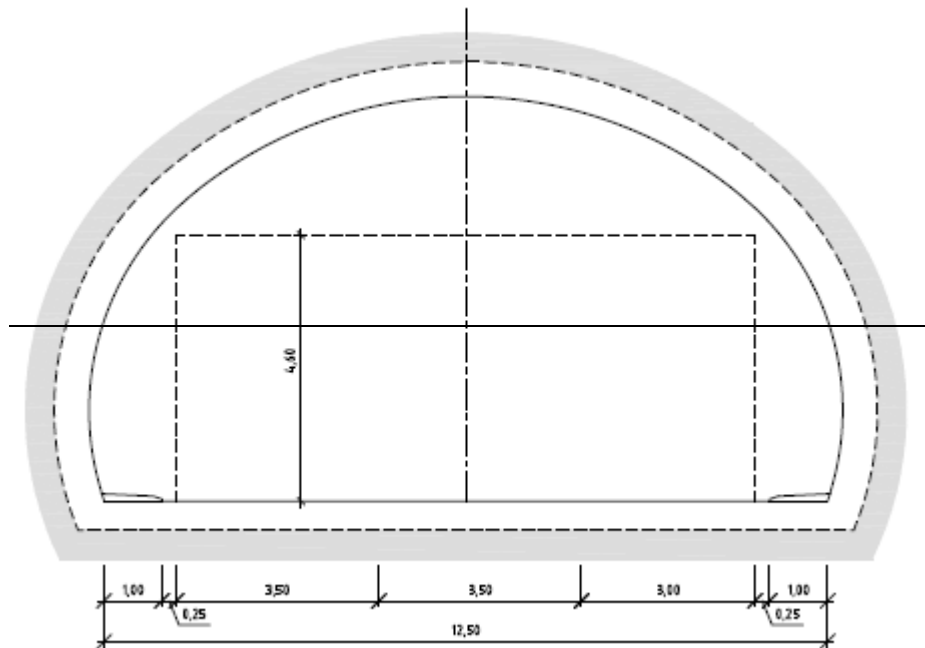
Tunnelprofil T11,5 (mål i m).
